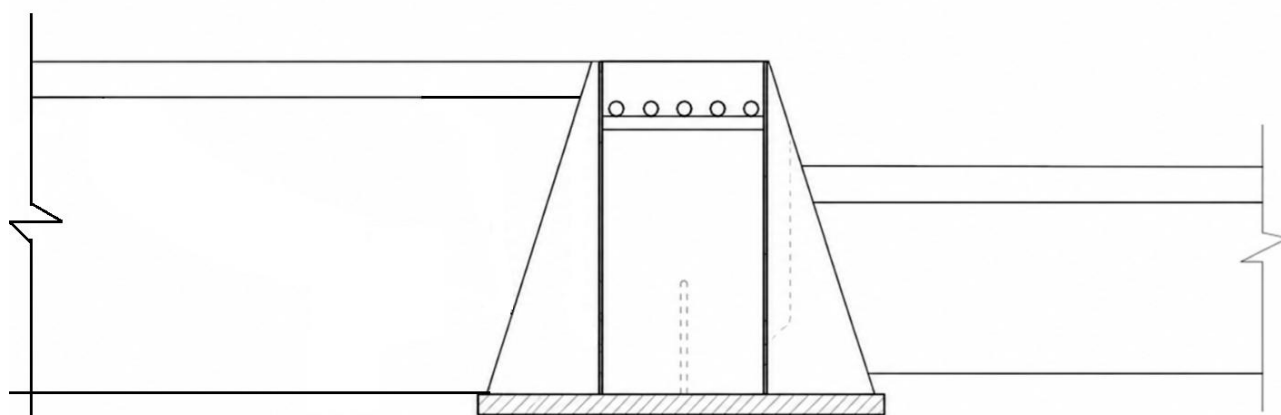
Схема сталезалізобетонної балки з прихованим розташуванням у перекритті
